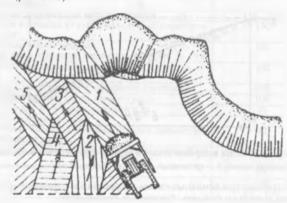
Вскрышные работы бульдозерами при отсыпке грунта в выработанное пространство карьера (цифры показывают последовательность проходов).
